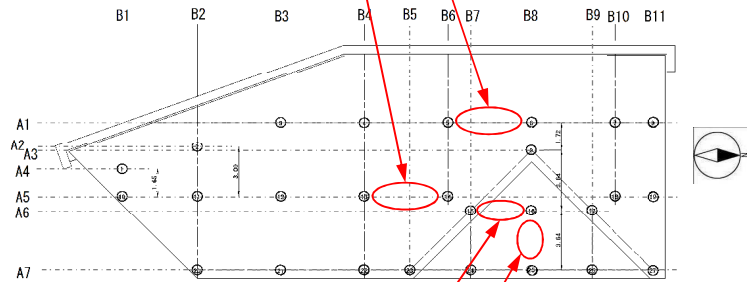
搬出入施設・車両乗降部 平面図 (下部工：海水面より上)
